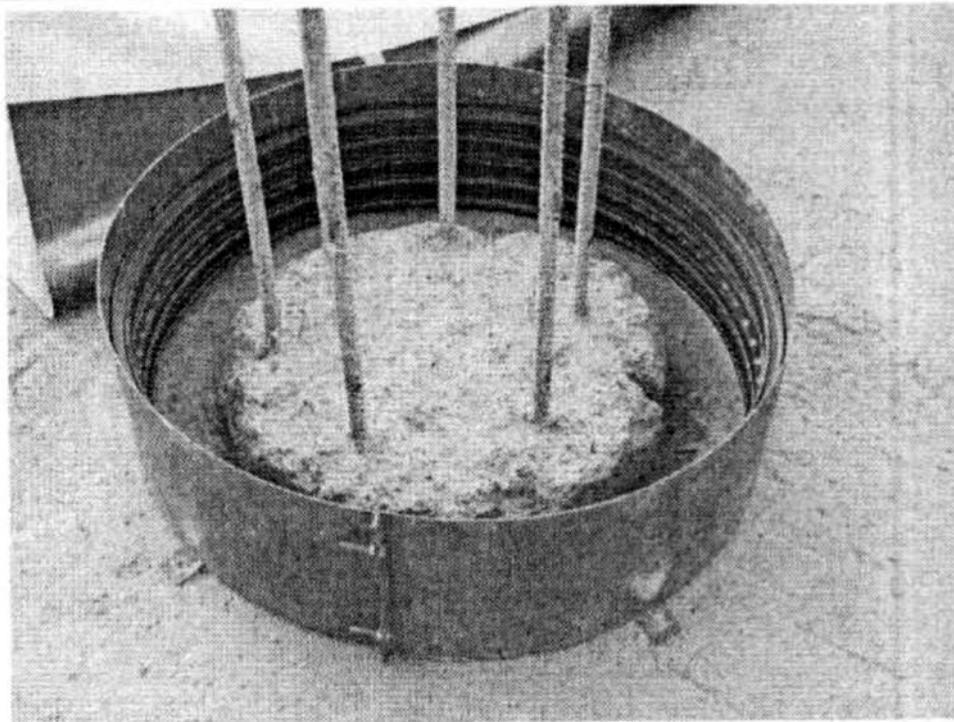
Установка опалубки оголовка бетонной сваи
